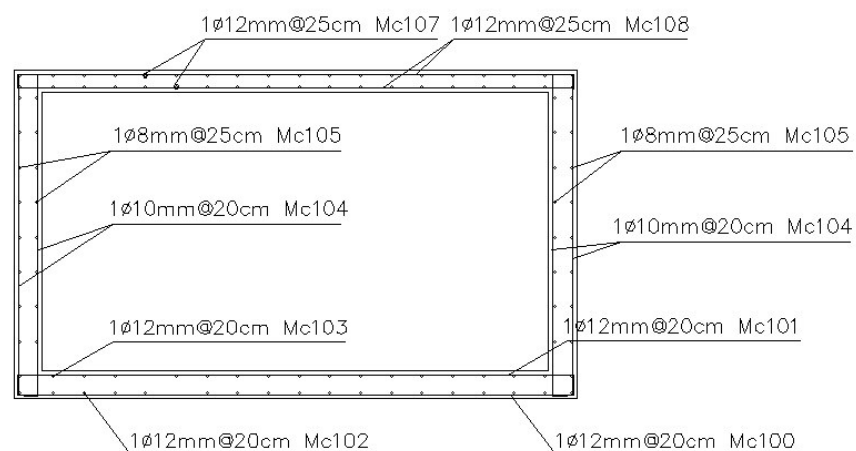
Corte longitudinal, armado de paredes, losa de fondo y losa de cubierta
